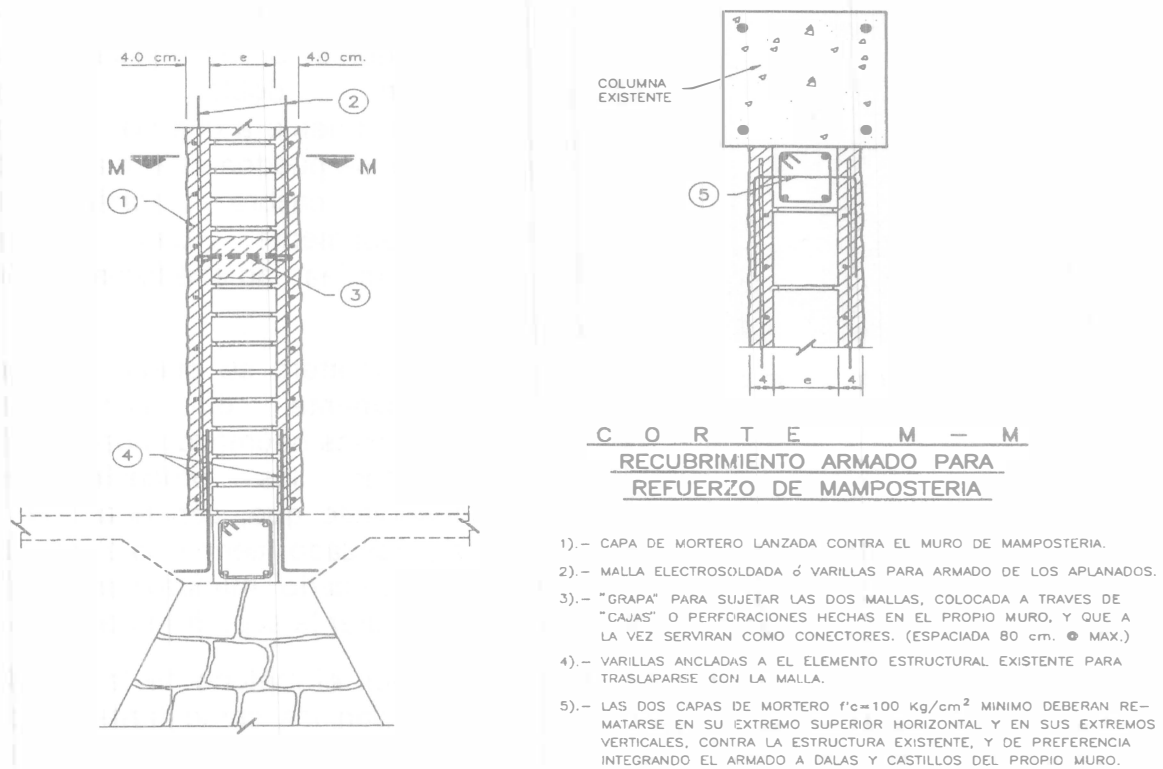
Recubrimiento armado para rehabilitación de mampostería (de la Torre, 1995).
